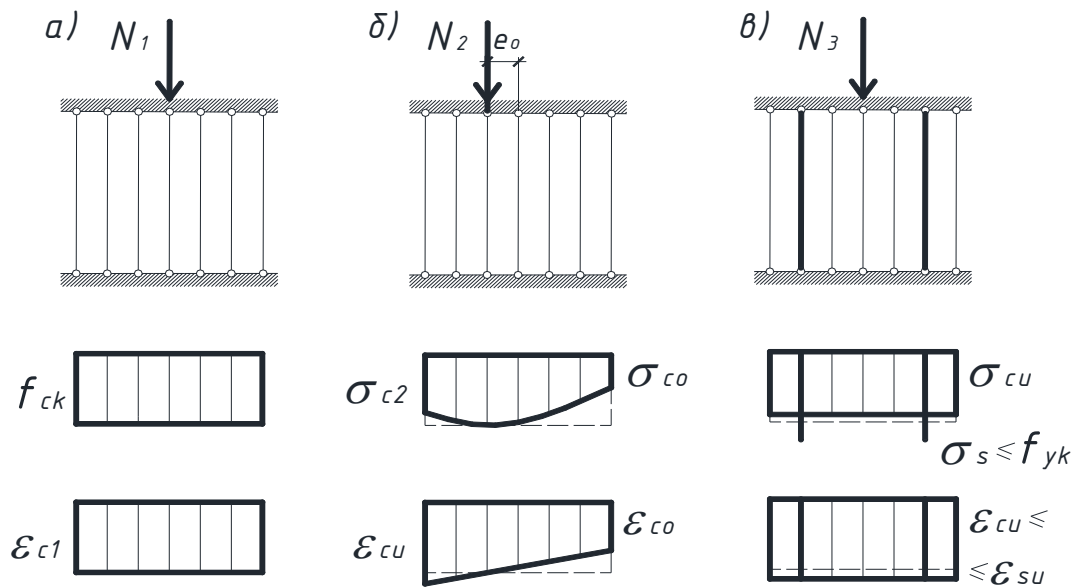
До перерозподілу напружень в перерізах стиснутих бетонних та залізобетонних елементів
